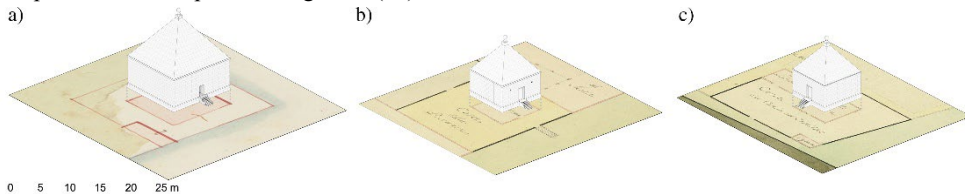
Ricostruzione 3D delle polveriere di San Clemente (a), Lazzaretto Vecchio lato est (b) e ovest (c) (elaborazione degli autori, 2024).
